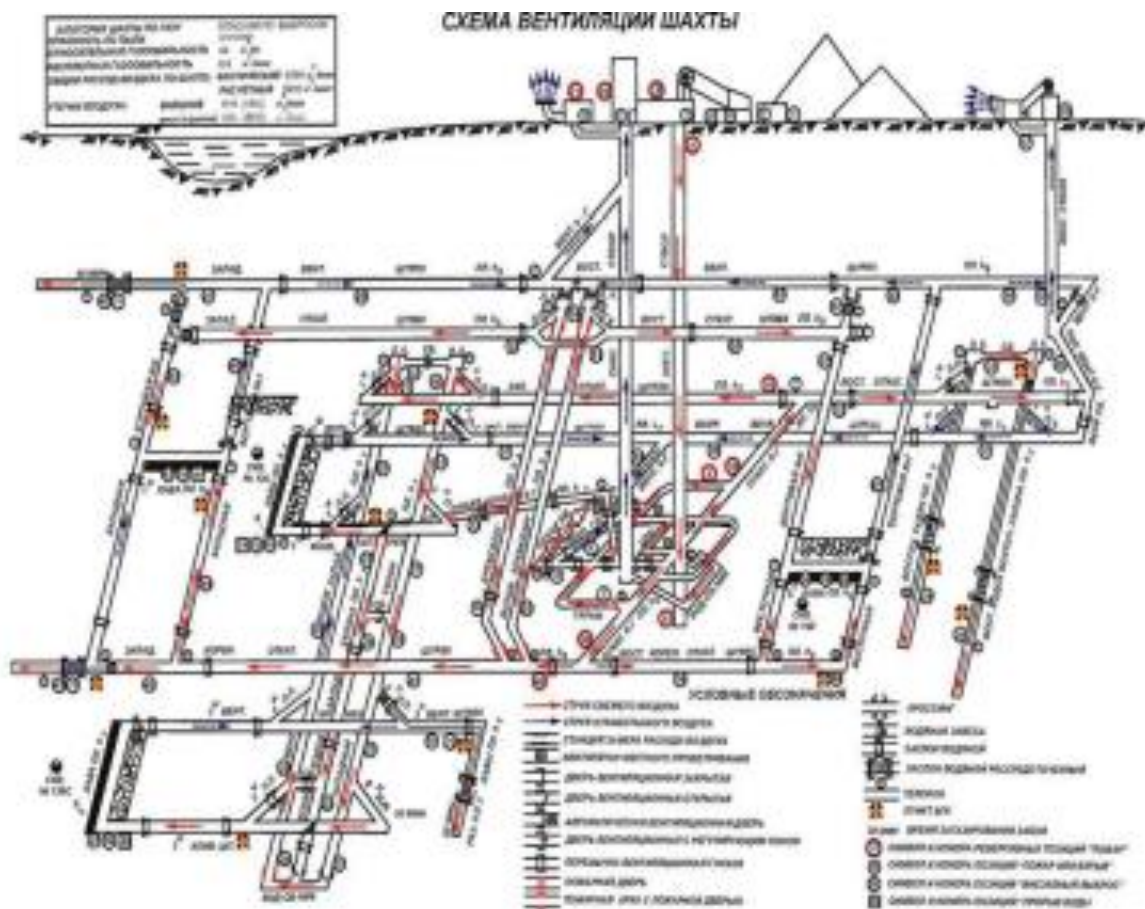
Схема вентиляції шахти до плану ліквідації аварій (взято з відкритих джерел)
